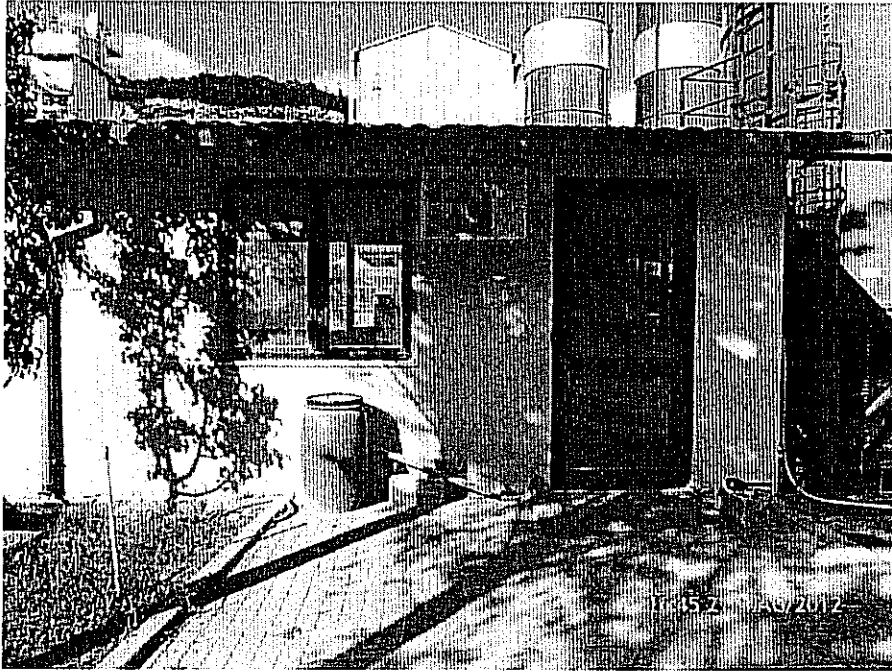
Manufatto edilizio a servizio dell'impianto di calcestruzzo
